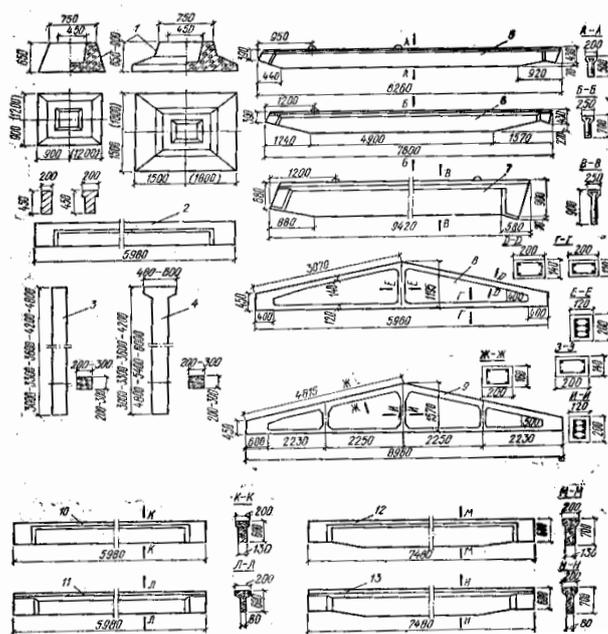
Унифицированные сборные железобетонные изделия для строительства сельскохозяйственных зданий:
